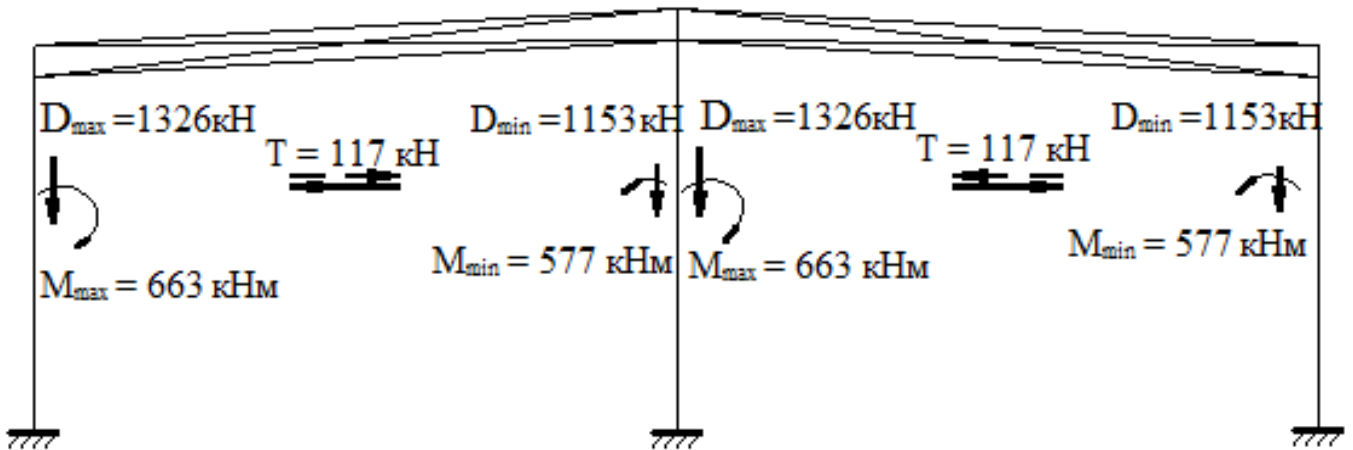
(а) Схема приложения крановых нагрузок №1: кран находится вблизи колонны А пролета АБ, и вблизи колонны В пролета ВВ.
